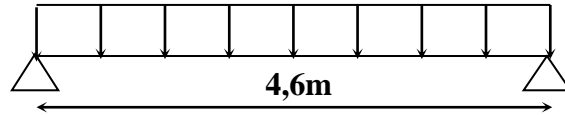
Schéma statique de la poutre de chaînage à l'ELS.
